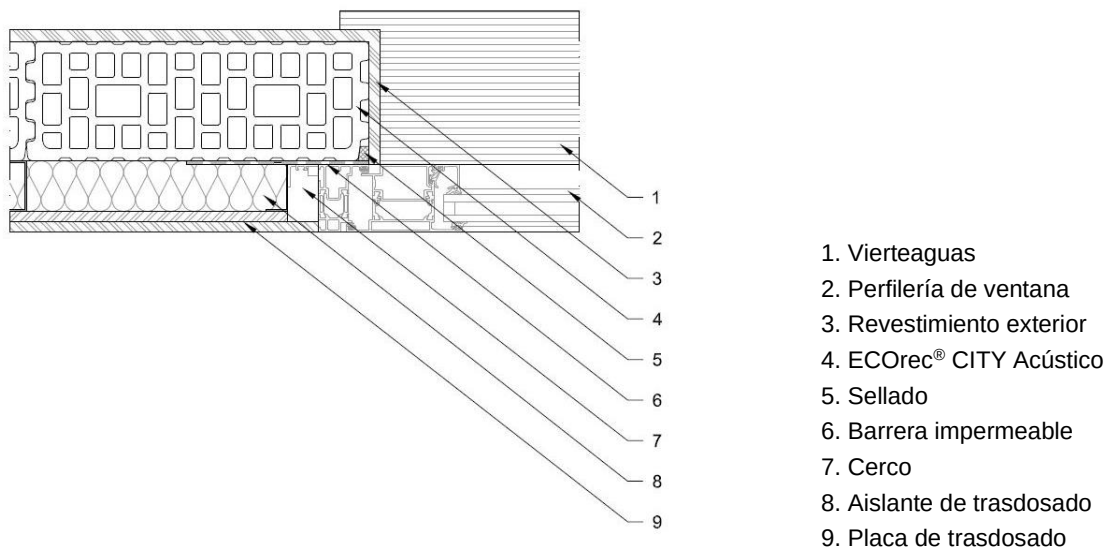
Encuentro horizontal con carpintería en fachada (ventana).
